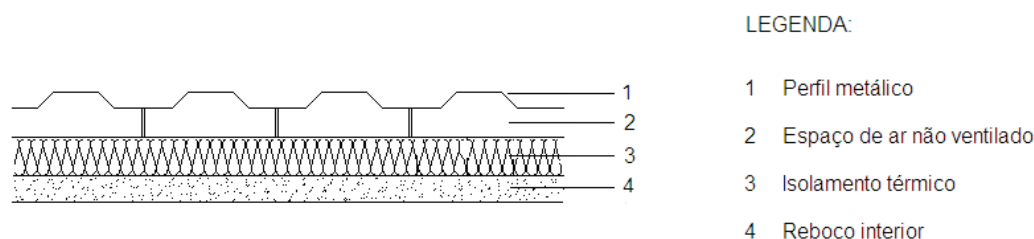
Pormenor construtivo da cobertura metálica, sem barreira pára-vapor.
